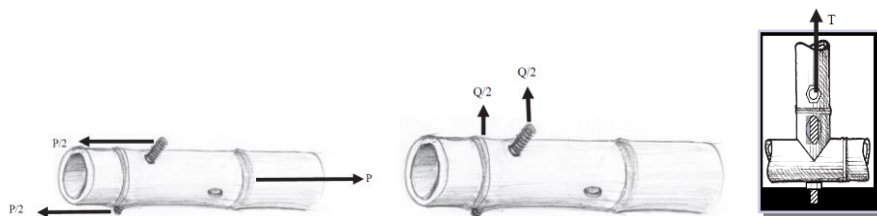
Ligações aparafusadas - (cit. Ministerio de Ambiente, V.y.D.T.-R.d.C., 2012)
